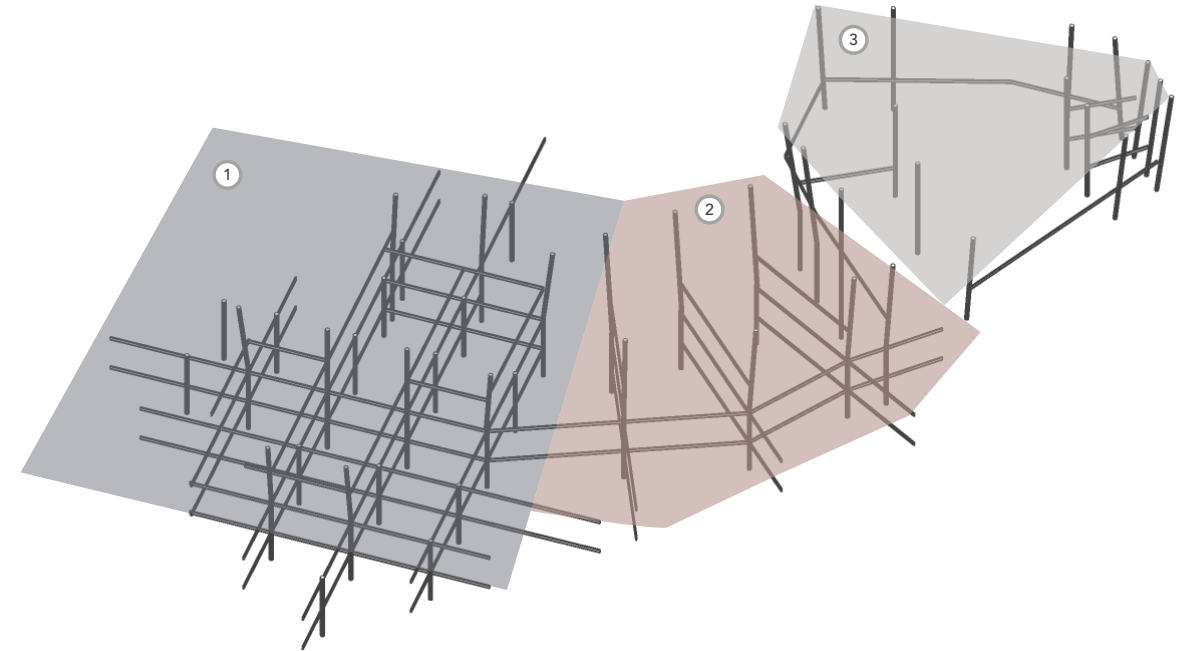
Elementos Constructivos y Espacialidad, Segundo Piso
